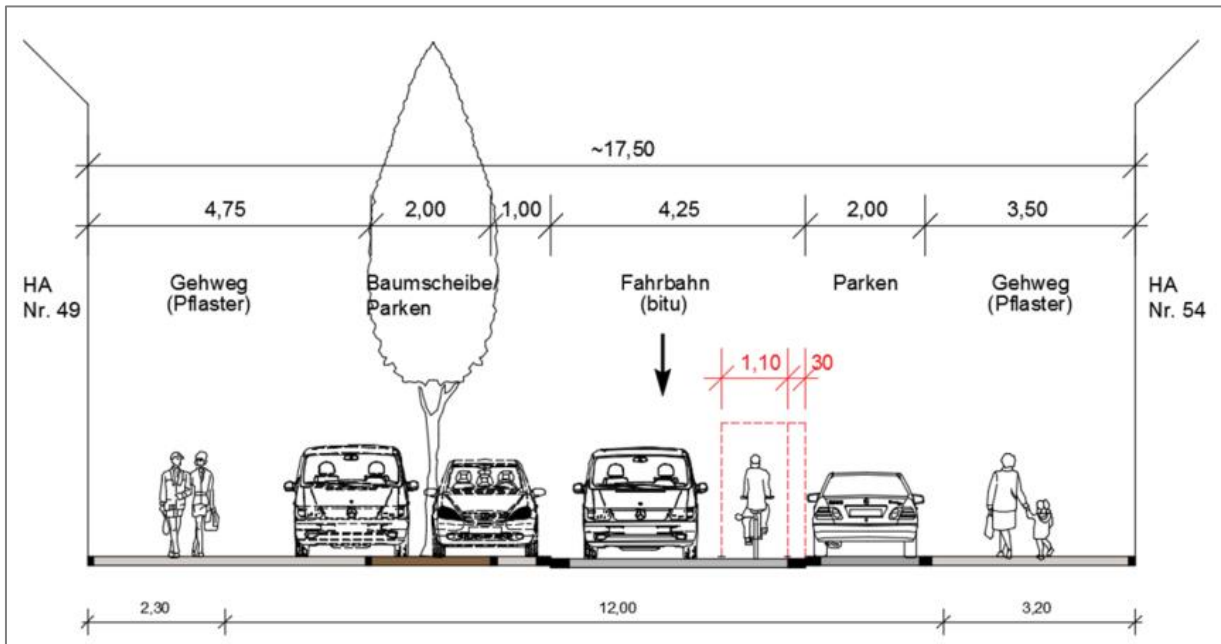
geplanter Querschnitt mittlere Bahnstraße
